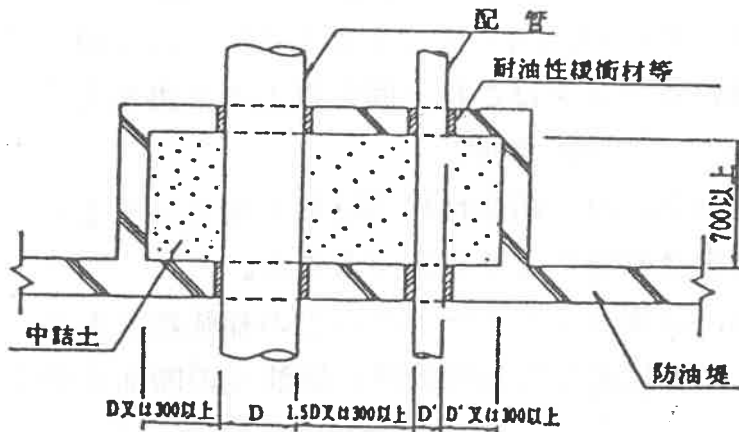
鉄筋コンクリートによる配管貫通部の保護措置の例
